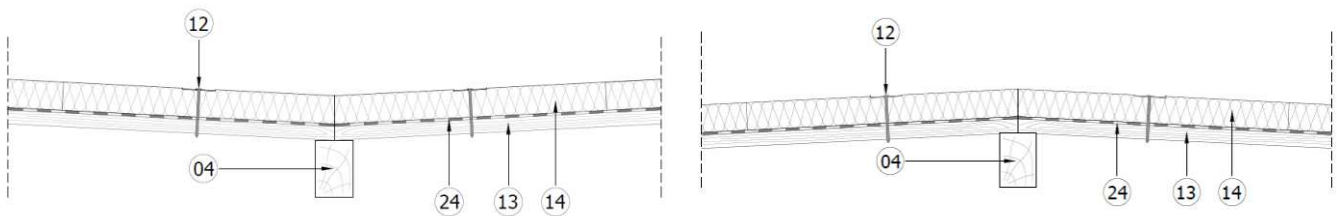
Exemple de recouvrement au droit d'une paroi verticale
